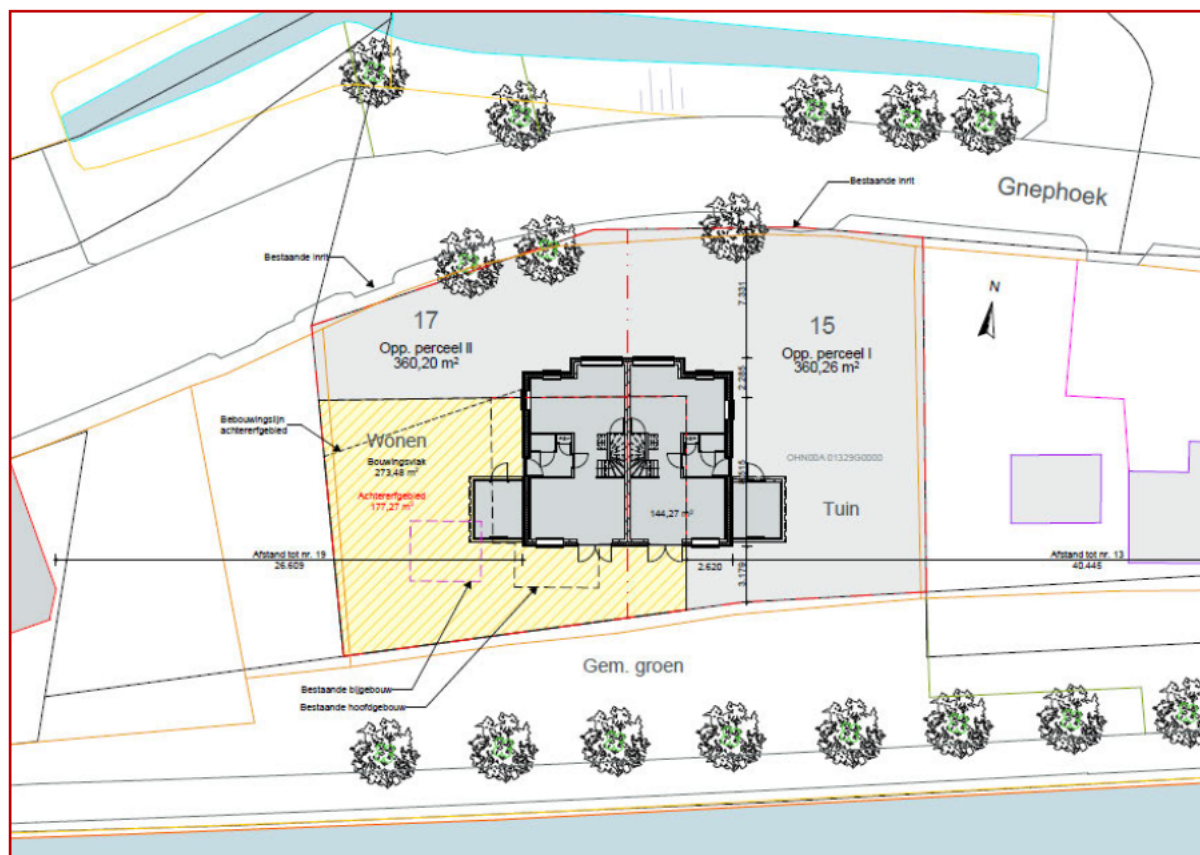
Weergave onderzoeksomgeving met aanduiding planlocatie
